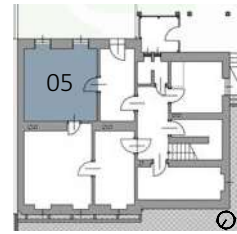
Grundriss UG 05 Gartenzimmer, M=1:100.
